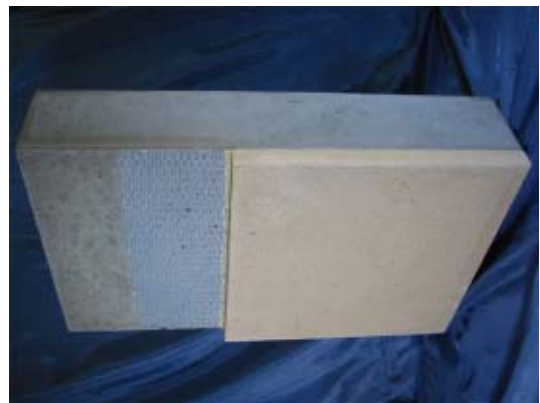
「ビジュアルコンクリート」の断面構成モデル
